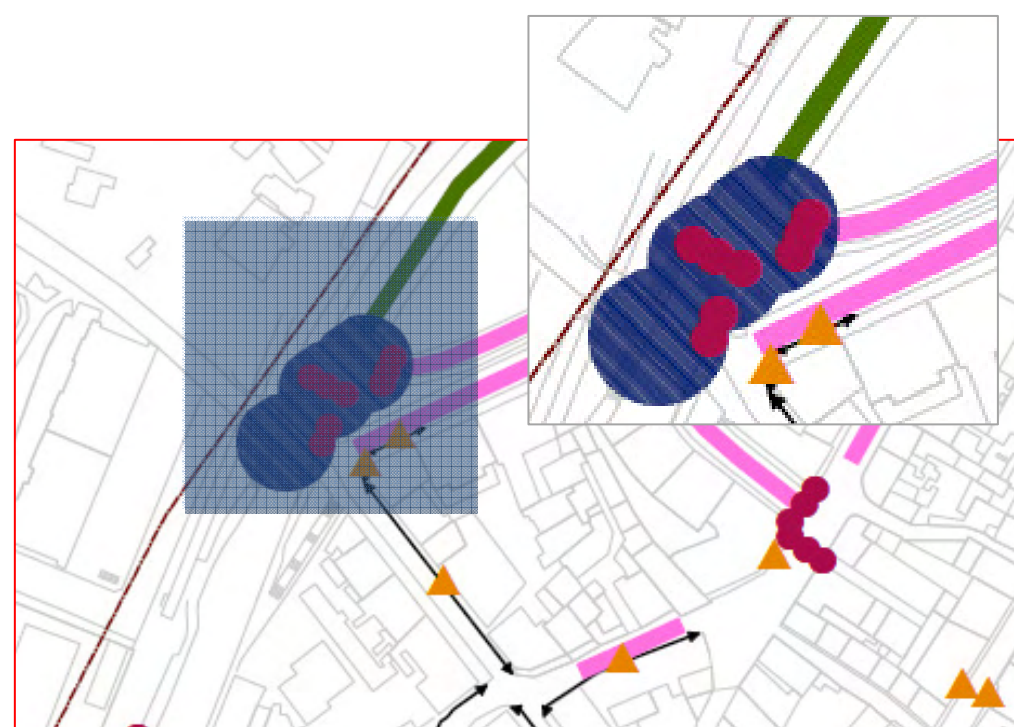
Extracto de Plantas de Tipologias de Intervenção (1).
